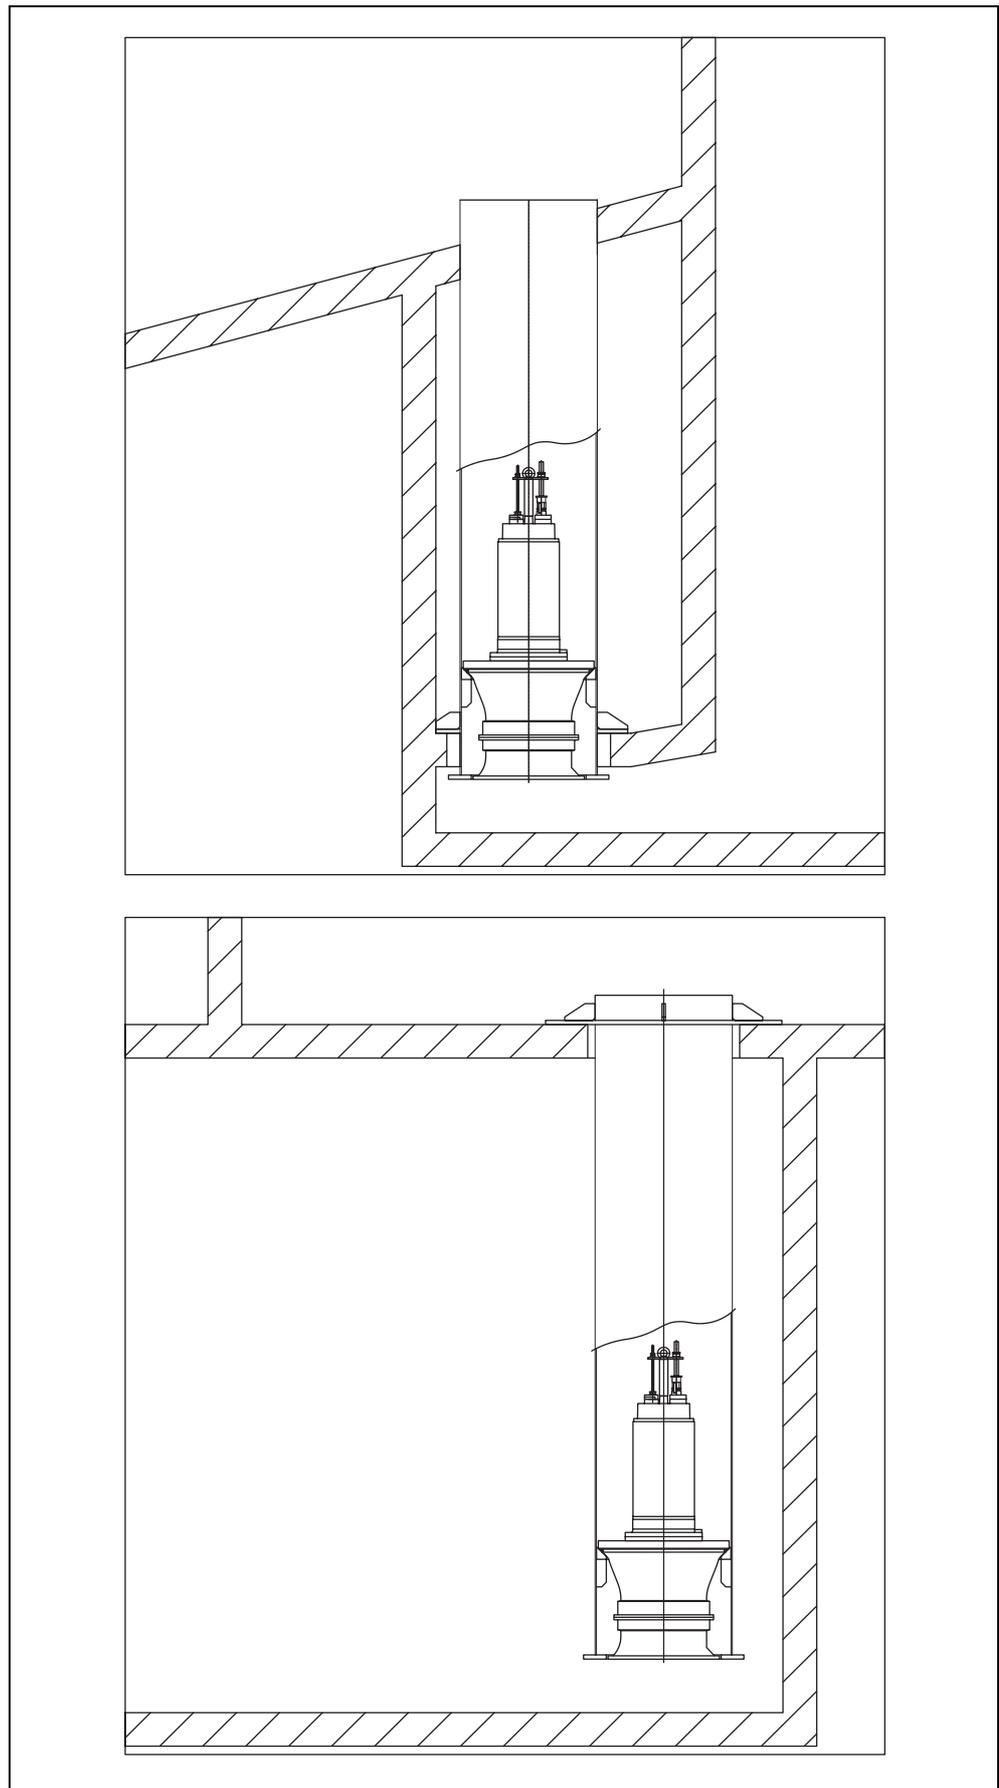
Einbau im Rohr in gedeckter Einlaufkammer und im Rohr-Überlaufausführung
